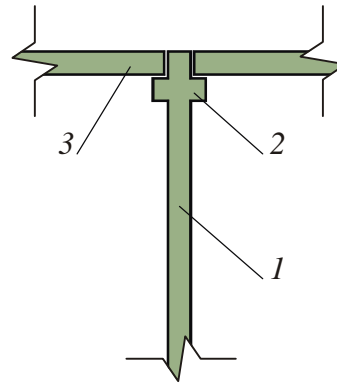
Конструкция перекрытия по несущим железобетонным перегородкам:
